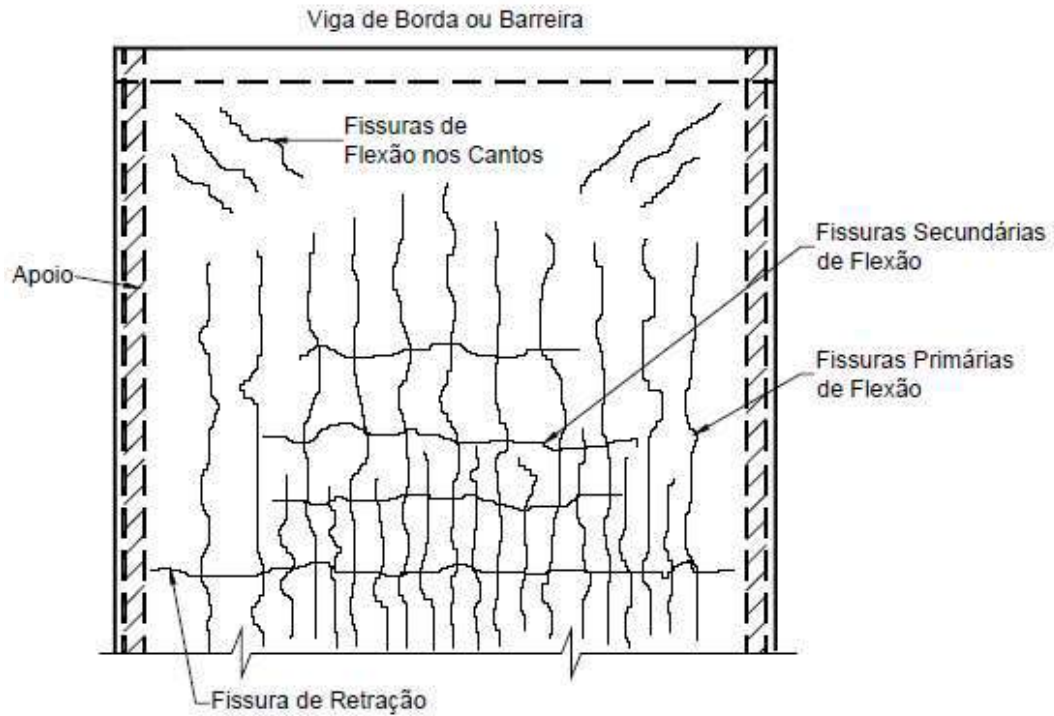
Fissuras na laje próxima aos apoios.
